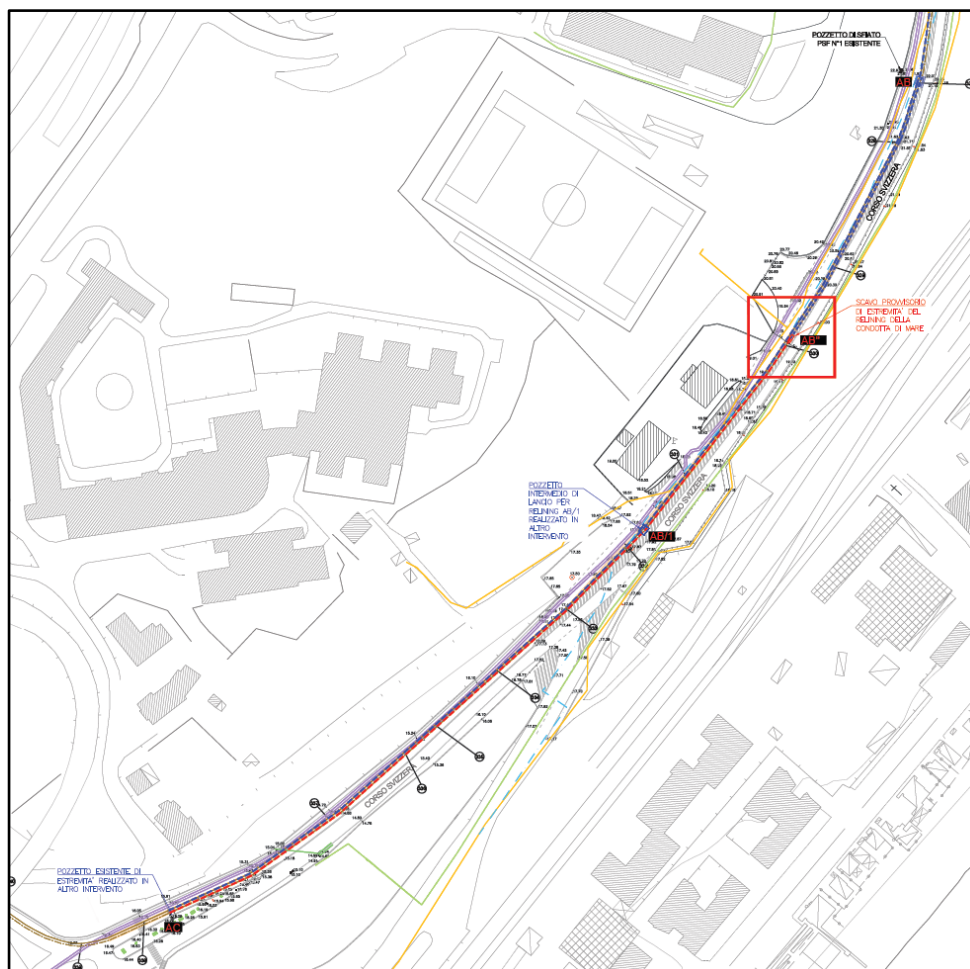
Stralcio della planimetria di progetto (pozzetto AB di sfiato, pozzetto AC di scarico)
